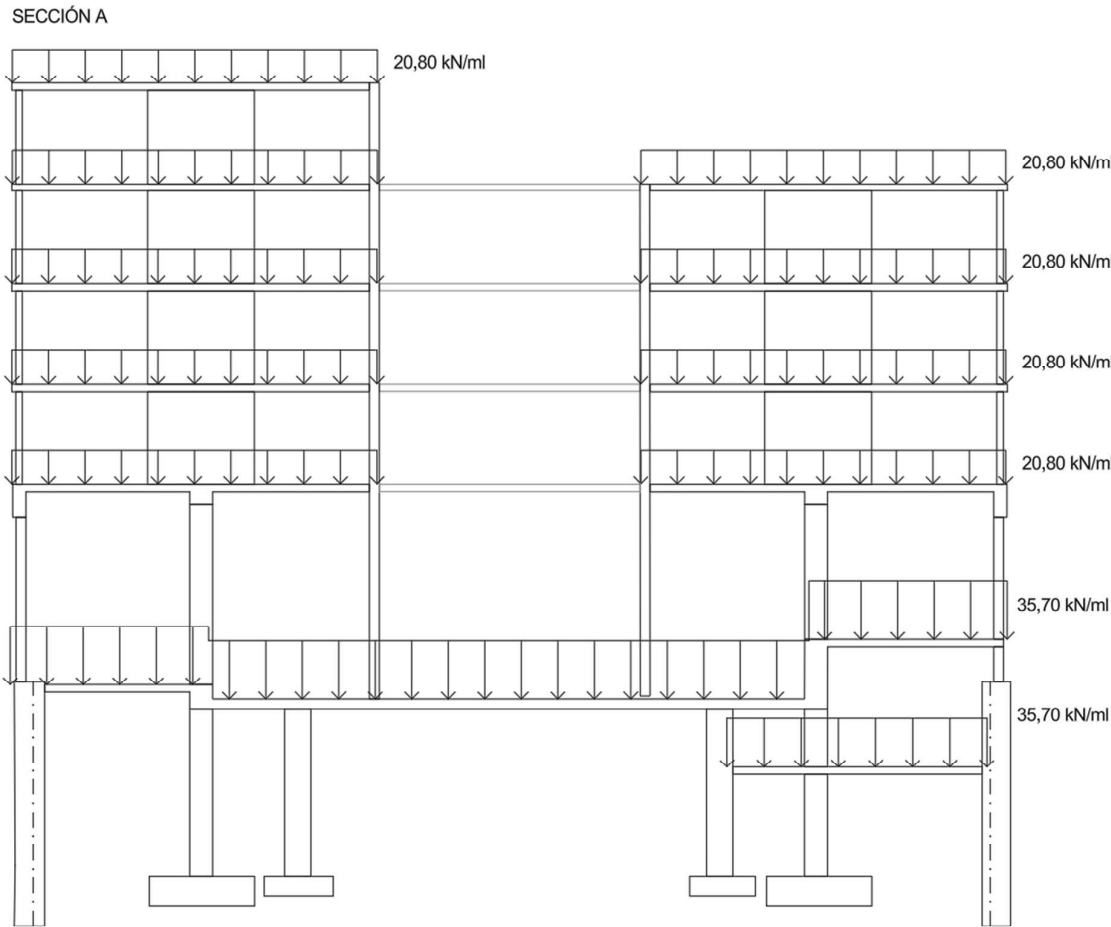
Cargas aplicadas en los pórticos analizados – Sección A (estado inicial y estado de proyecto)
